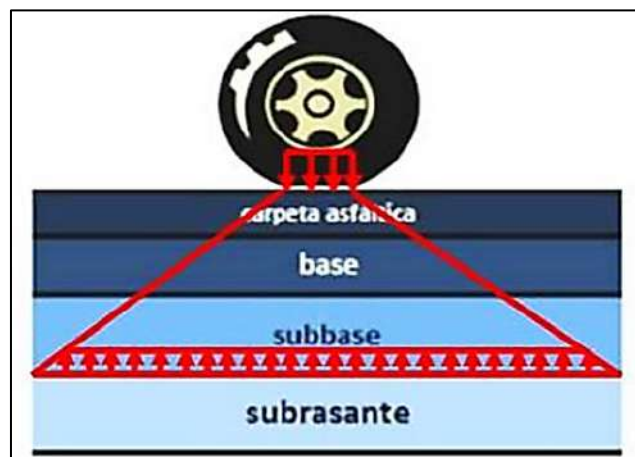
Comportamiento estructural de pavimento flexible Rodríguez [43]
